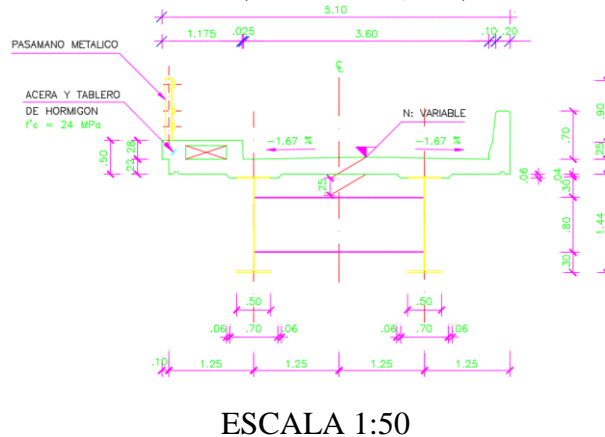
Corte transversal del puente de hormigón armado La Concordia.
